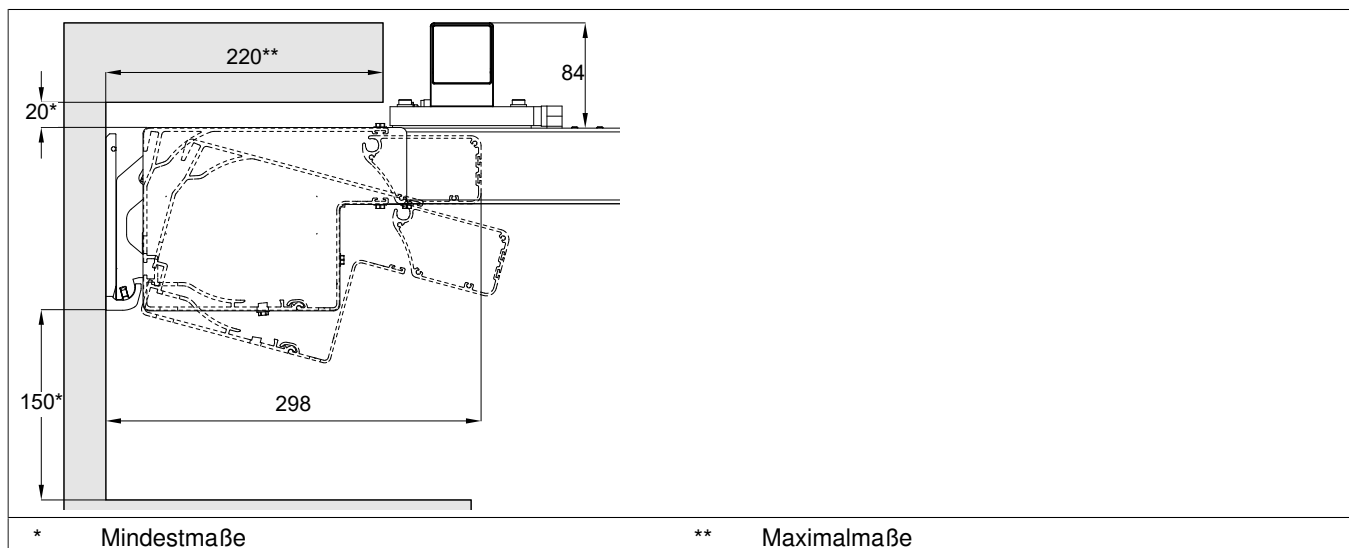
notwendiger Einbauraum bei mitlaufendem Verstärkungsprofil, Neigung 0° (alle Maßangaben in mm)
